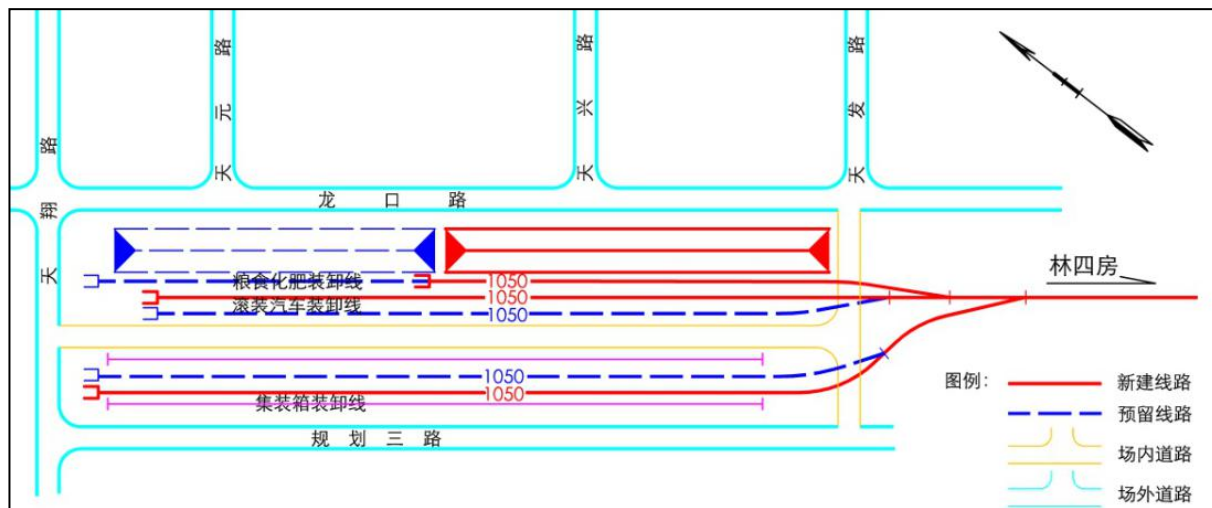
龙口路南侧设置装卸场平面布置示意图
